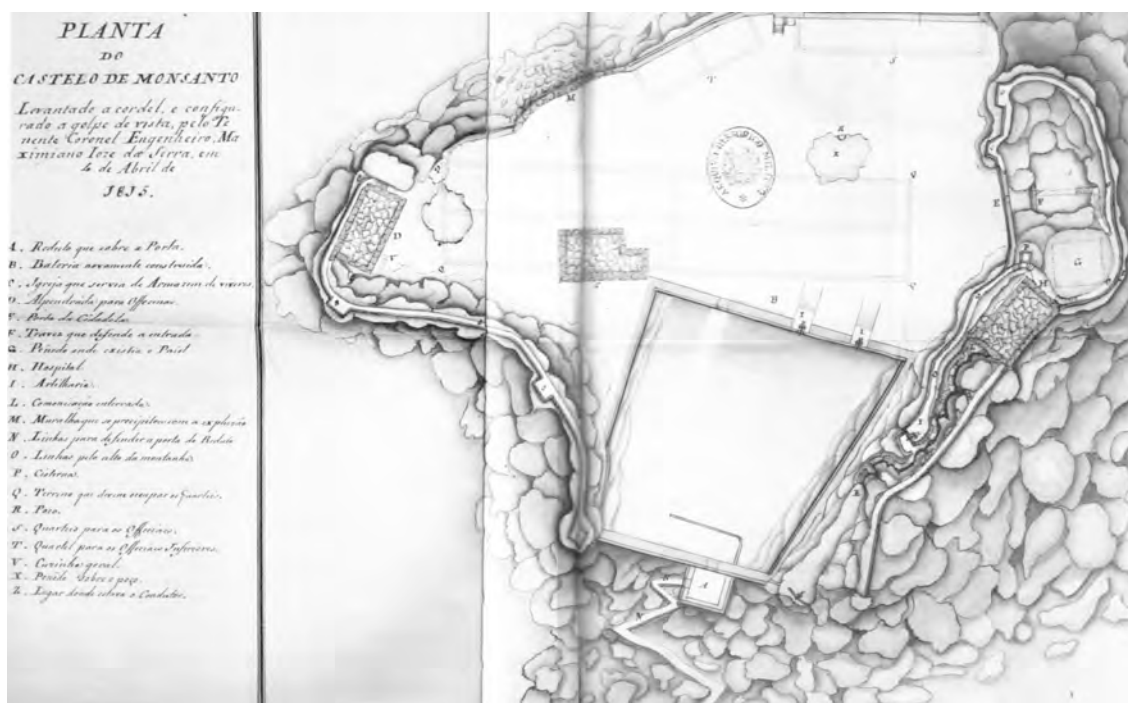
Planta do Castelo de Monsanto (Nunes, 2001, p.26).
